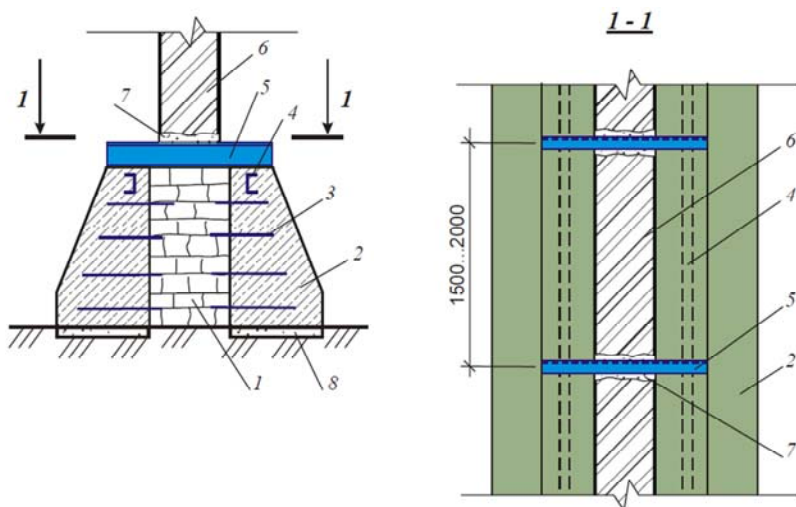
Уширение подошвы фундаментов монолитными бетонными банкетам:
